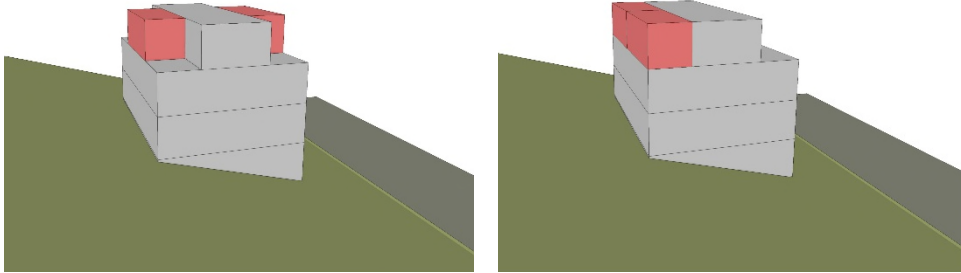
«Reguläre» Anordnung des Attikageschosses bzw. der Dachaufbauten (links) sowie hangseitig fassadenbündige Anordnung der Dachaufbauten (rechts) (Quelle: EBP)
